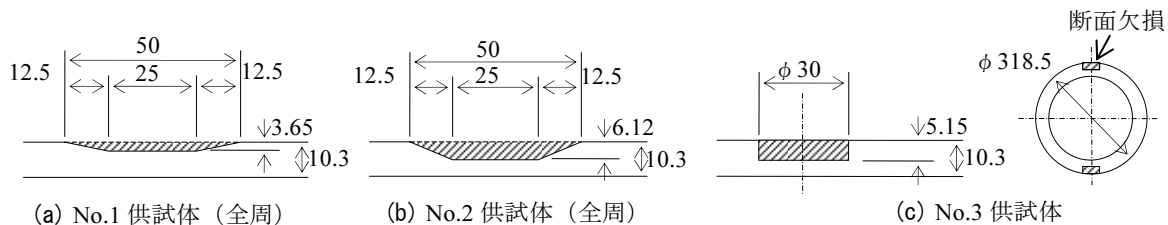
鋼管供試体の断面欠損形状 (単位: mm)
